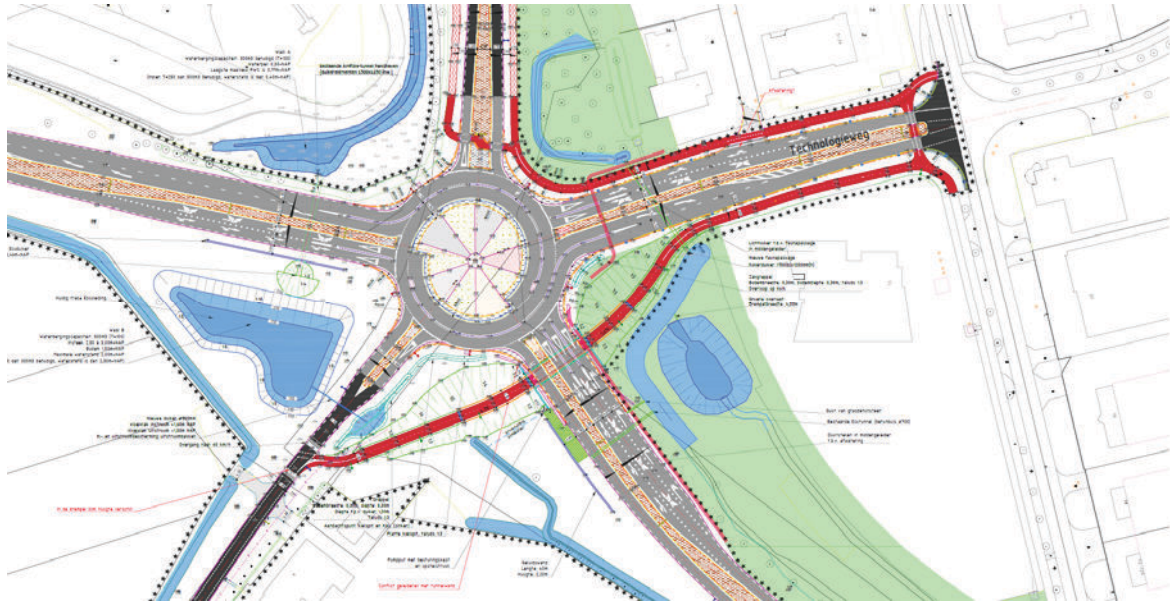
Bovenaanzicht nieuwe fietspad en locatie van de geplande tunnel en toeritten (Bron: PDOK luchtfoto 2019).
